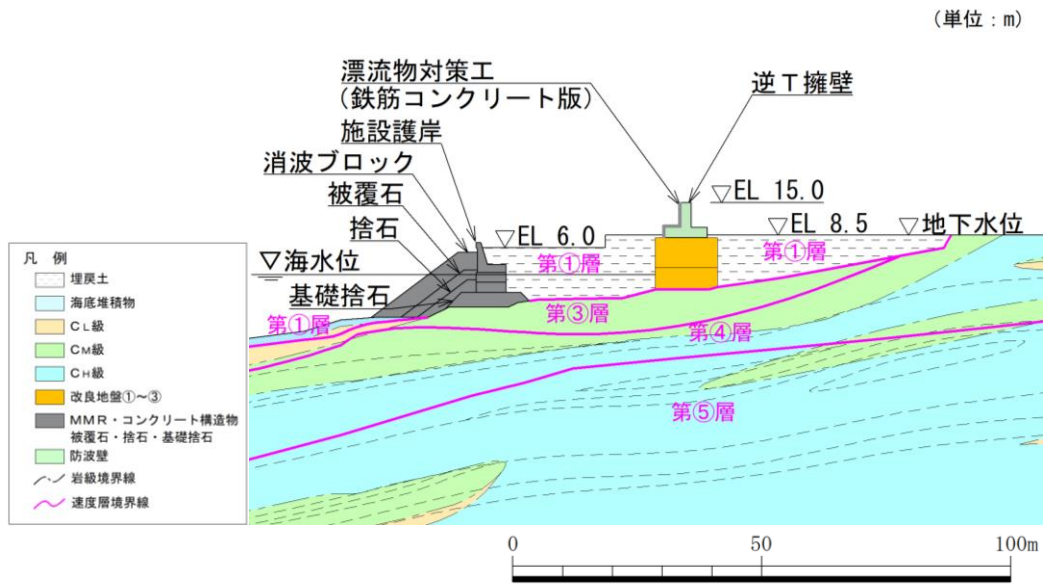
防波壁 (逆 T 擁壁) の横断面図 (①-①断面)
